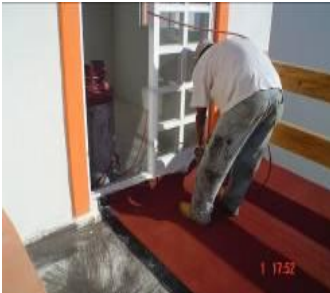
Detalle tipo para la colocación de impermeabilizantes
